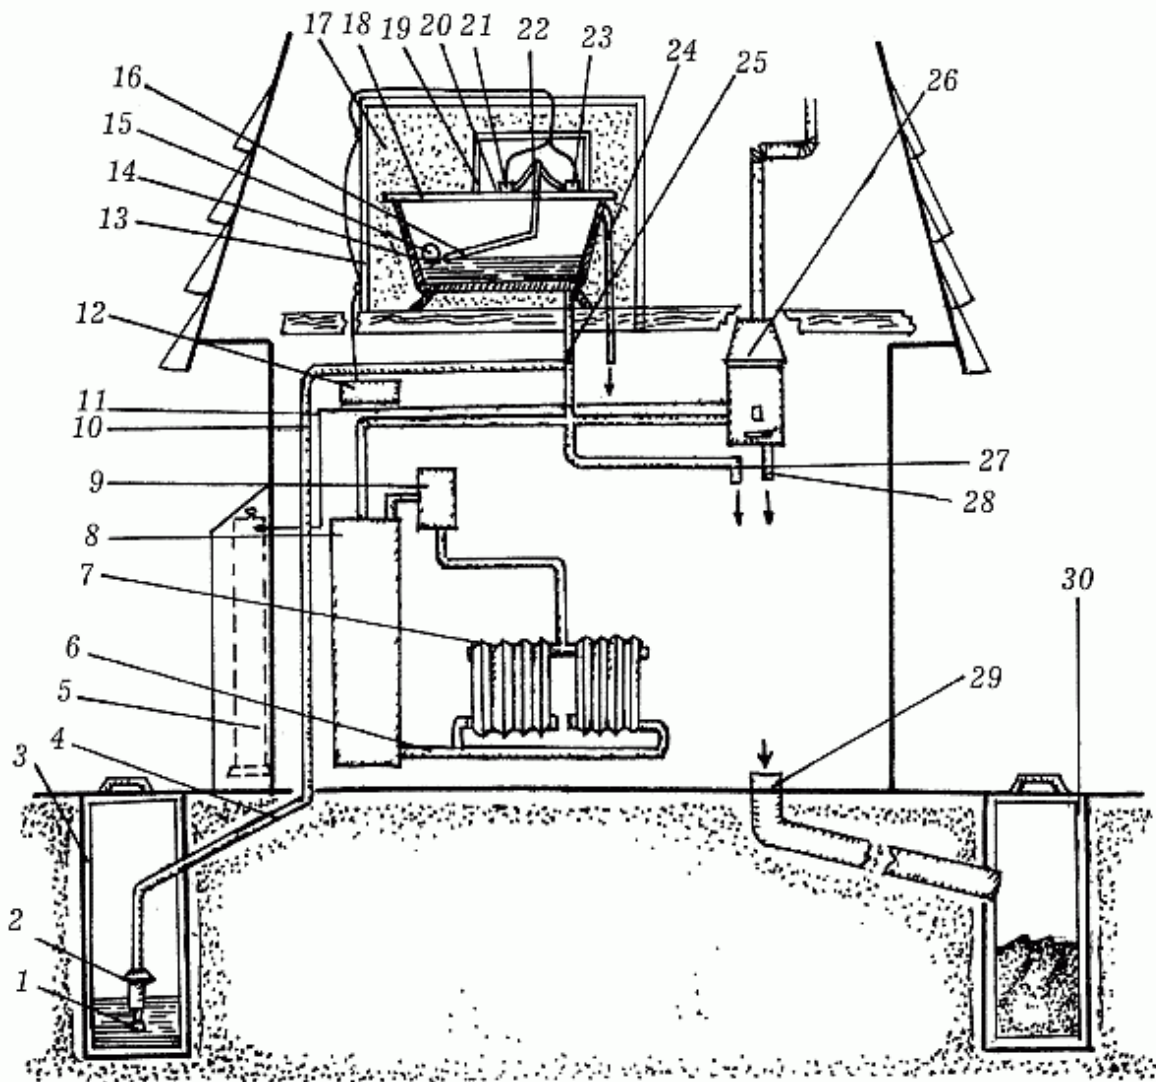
Схема оборудования дома автономным водопроводом с верхней подачей воды: 1 – водозаборник с фильтром; 2 – электронасос; 3 – колодец; 4 – подающая труба; 5 – газовый баллон; 6 – обратная труба
